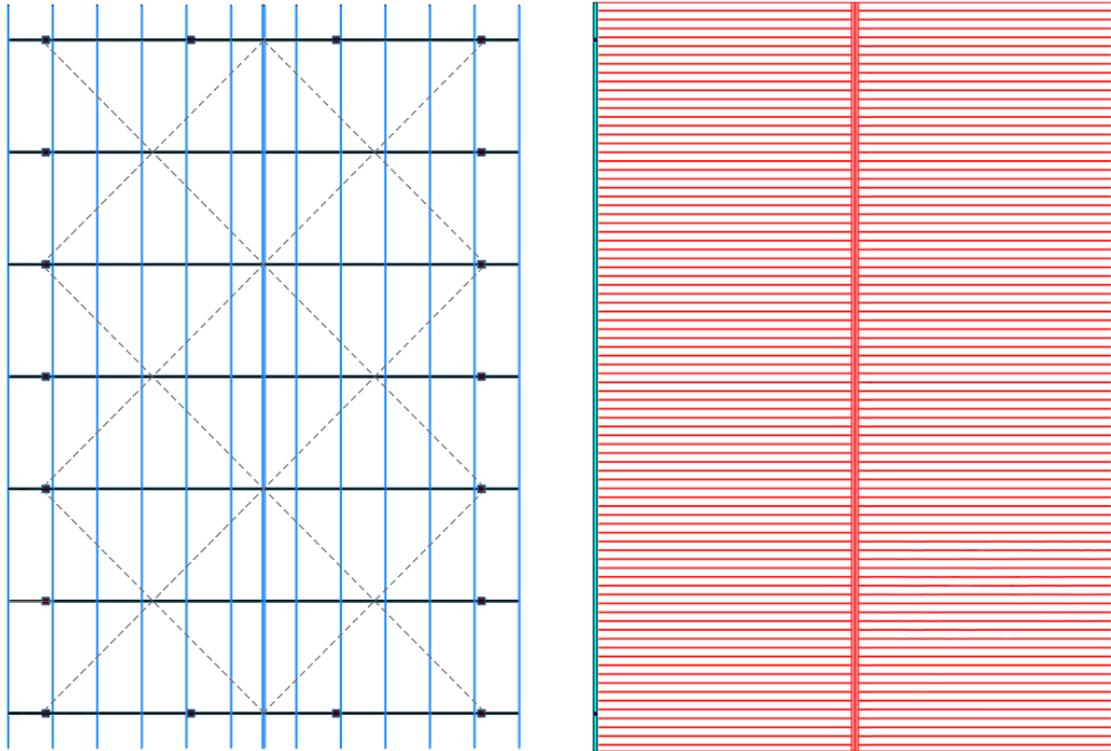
Plano en planta Módulo 1 - Entramado para segundo nivel
